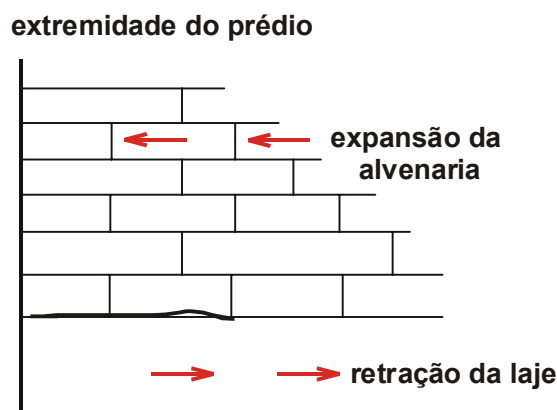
fissura na base da parede por retração da laje e expansão da alvenaria (BRICK INDUSTRY ASSOCIATION, 1991)
